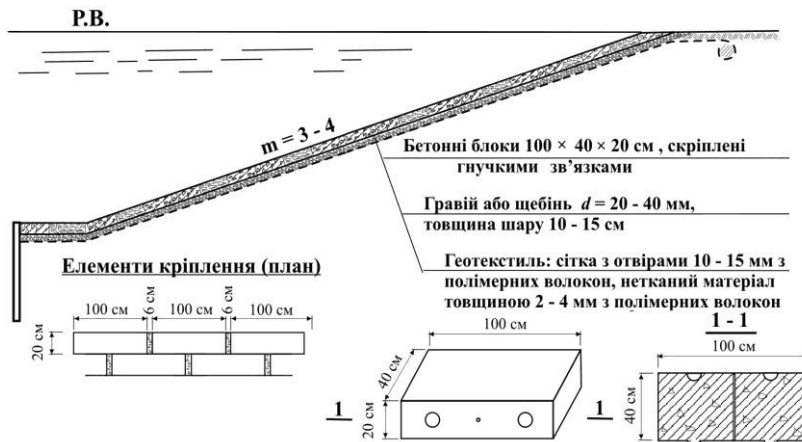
Кріплення з бетонних блоків з шаром щебеню
